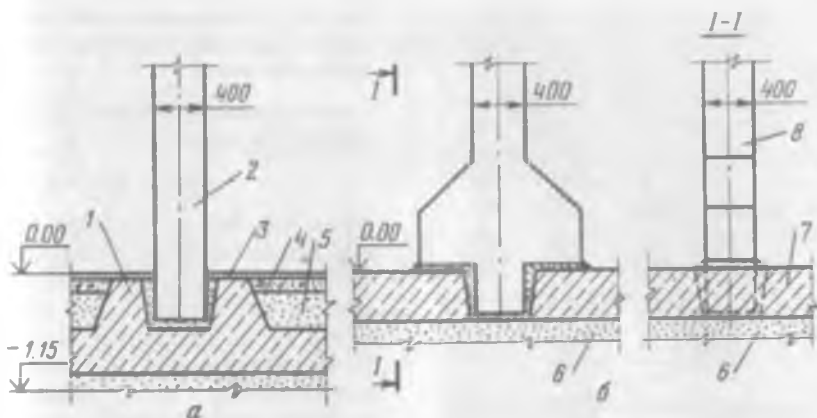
Сопряжение колонн подсилосного этажа силосного корпуса СКС-3 с фундаментами:
